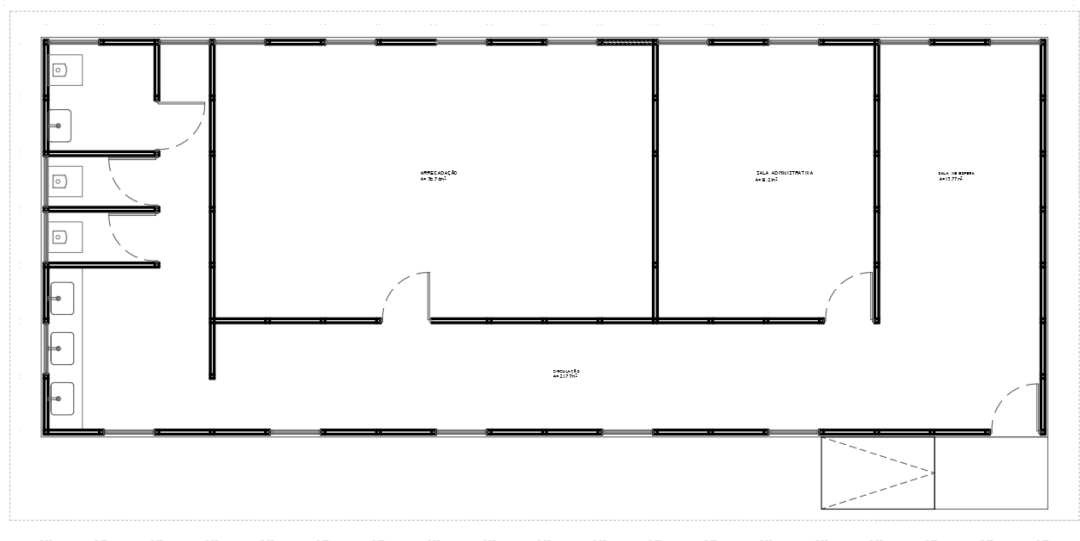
Planta Piso o Módulo Administrativo (Fonte: Autor)
